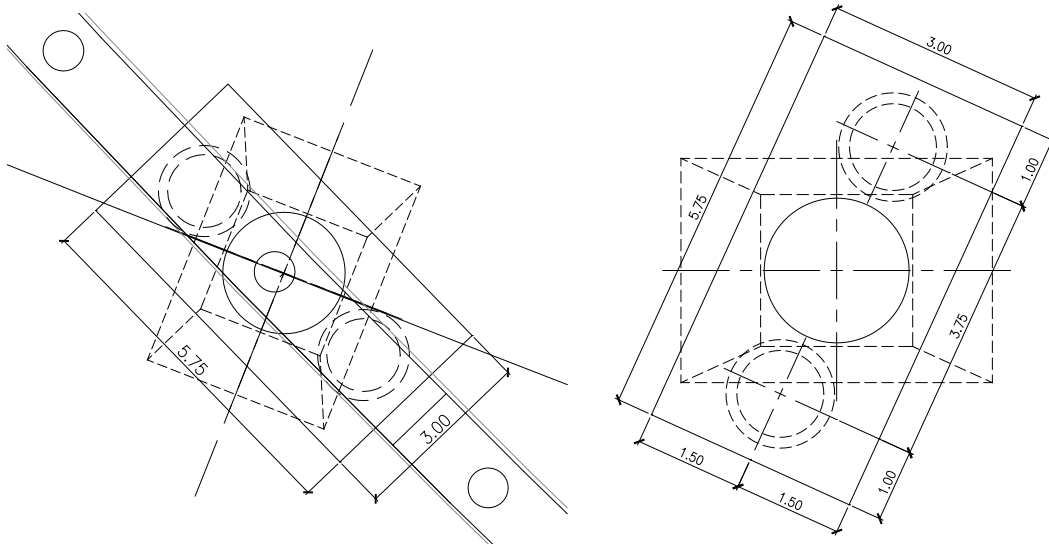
Planta de capitel y cabezal sobre la losa sup, del túnel.
